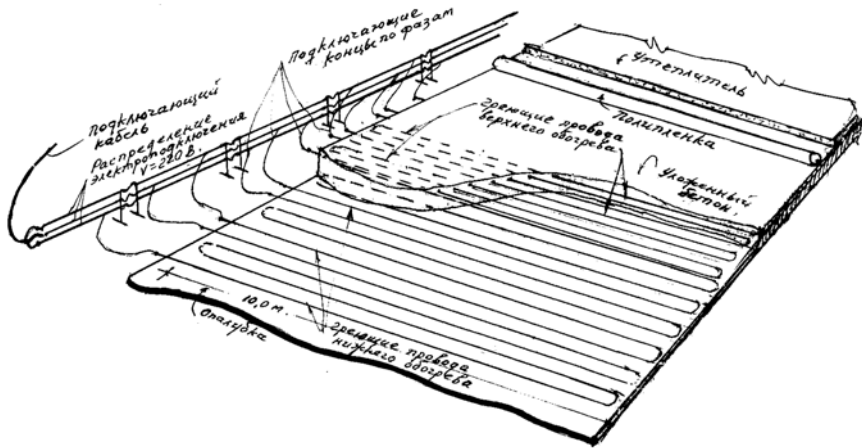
Пример подключения и прогрева плиты перекрытия с двухсторонним обогревом полимерными проводами
